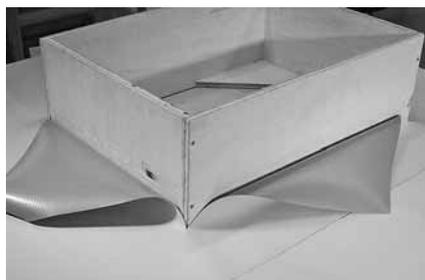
При устройстве примыкания кровельной мембраны к вертикальным поверхностям на внешних углах вентиля и т.п. (световой фонарь, парапет и др.) мембрану разрезают под углом 45°.
